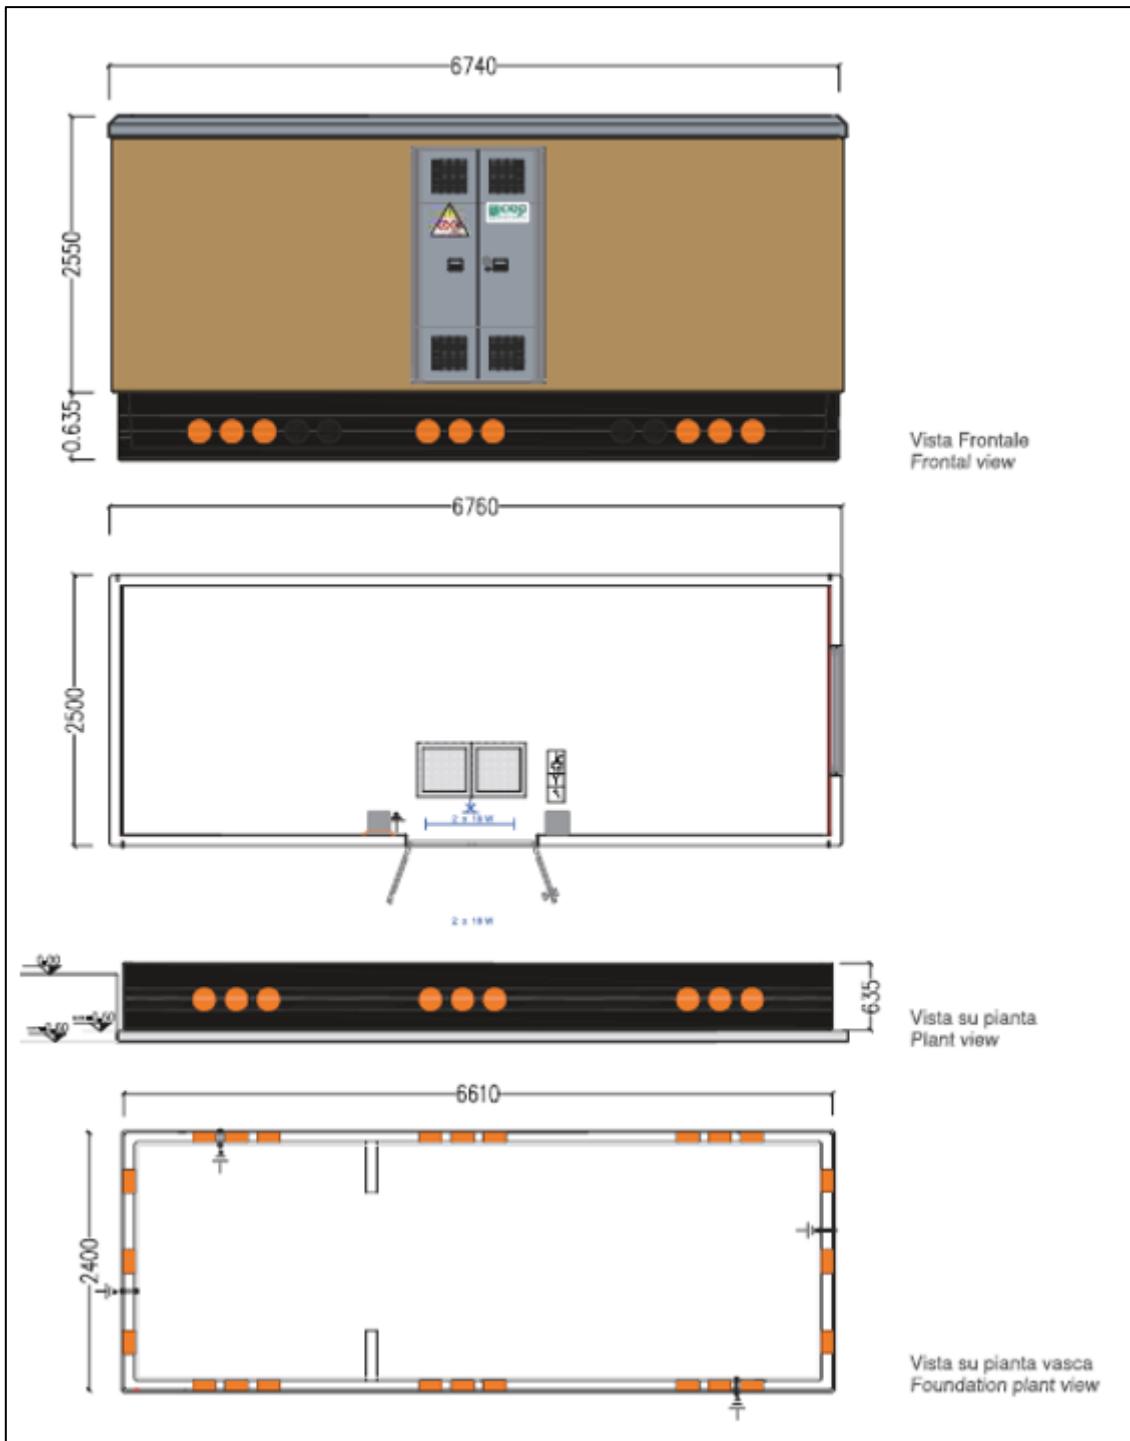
pianta e prospetto box misure da mettere a disposizione del Distributore
